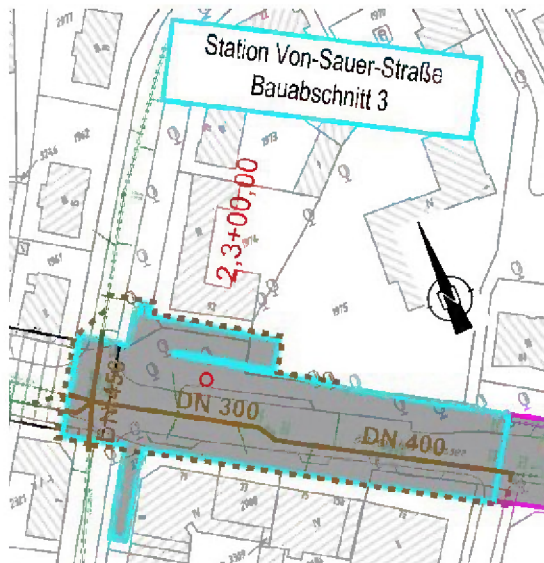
Sielplan Baubereich Station Von-Sauer-Straße (II), Bauabschnitt 3 (Stand 04.2019)
